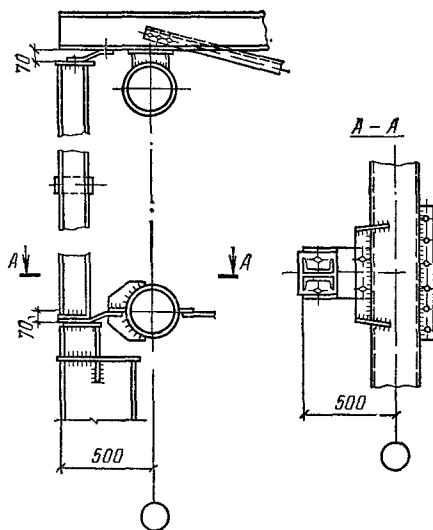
Опираие фахверковой стойки на покрытие из трубчатых ферм
